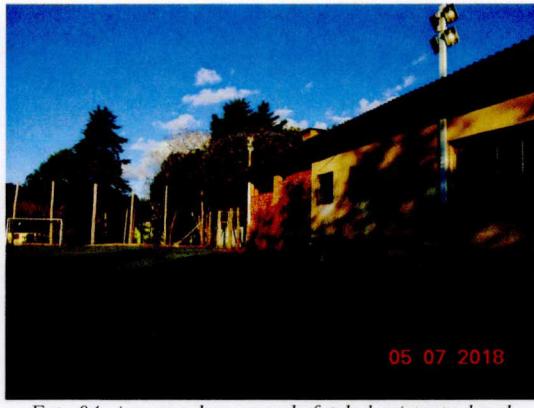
imagem do campo de futebol existente, local onde está prevista a execução da nova Quadra Coberta;
